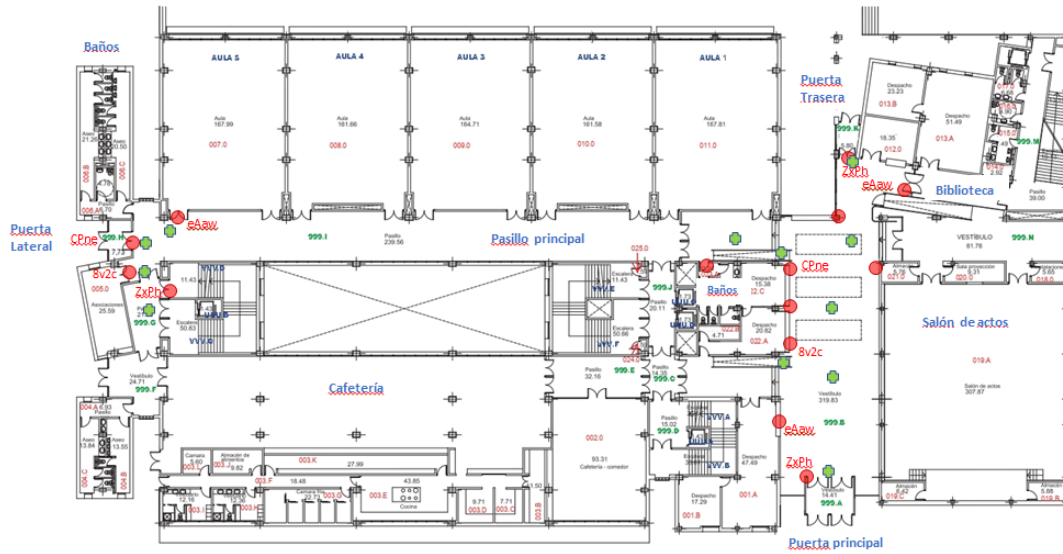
Mapa de la planta baja de la Facultad de Informática con la ubicación de los beacons (rojo) y los puntos de medición (verde).
